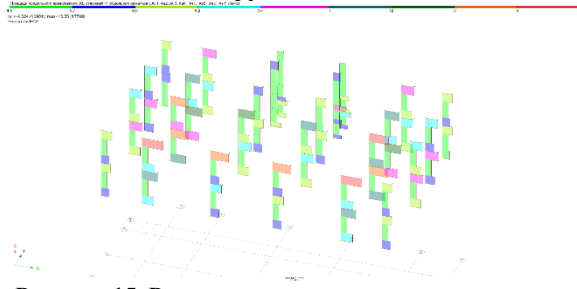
Расположение колонн и максимальная площадь армирование в колоннах на четвёртом и пятом этажах пятиэтажного каркасного железобетонного здания с внутренними и наружными каркасно-обшивными стенами.
